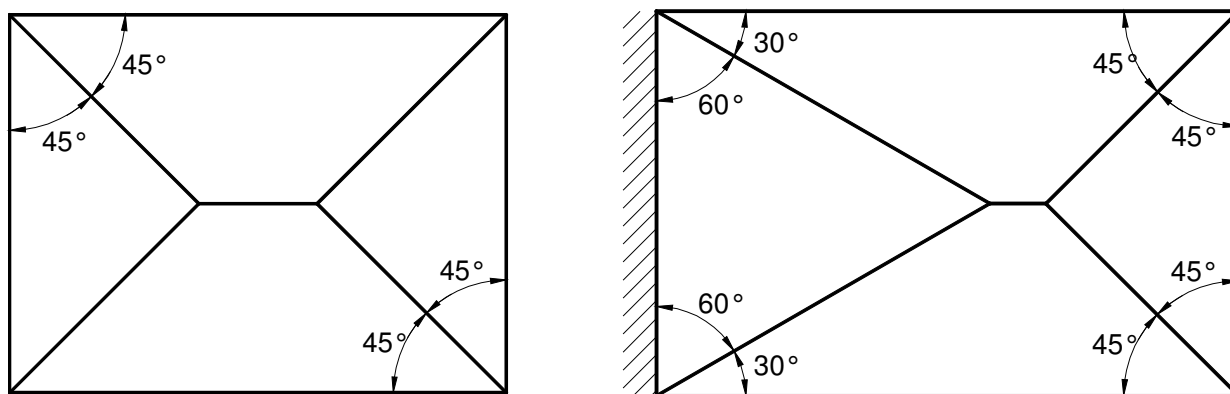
Definição das áreas de influência de carga para cálculo das reações de apoio nas vigas de borda das lajes armadas em duas direções.
